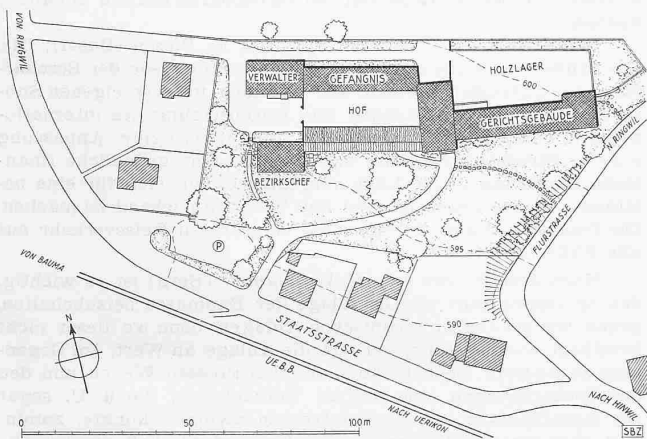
Bezirksgebäude Hinwil. — Lageplan Masstab 1:2000
